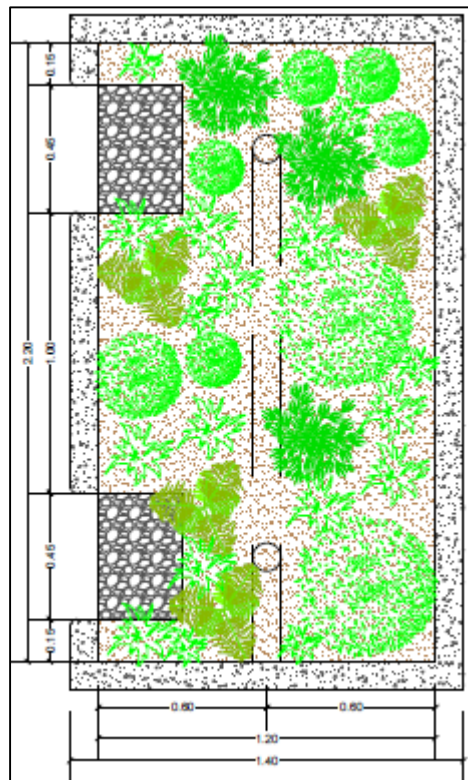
Vista en planta para zona de bioretención de 1.20 x 2.20 m
